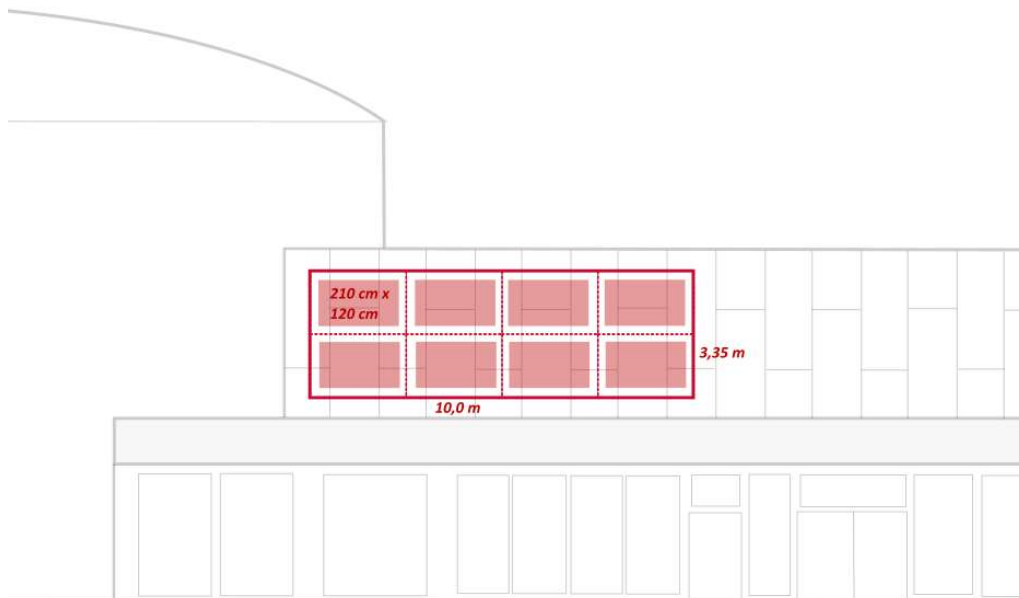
Sammelwerbeanlage Northwest-Fassade, Gebäudeteil T1
